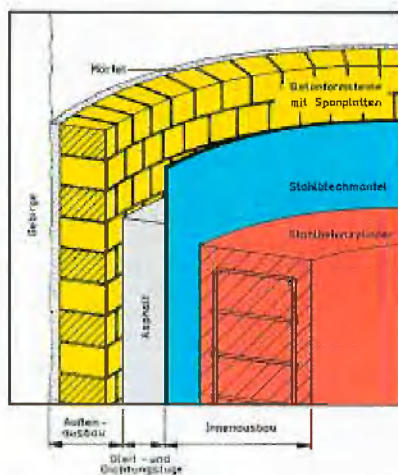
Stahl-Beton-Verbundausbau mit Asphalt hinterfüllung
